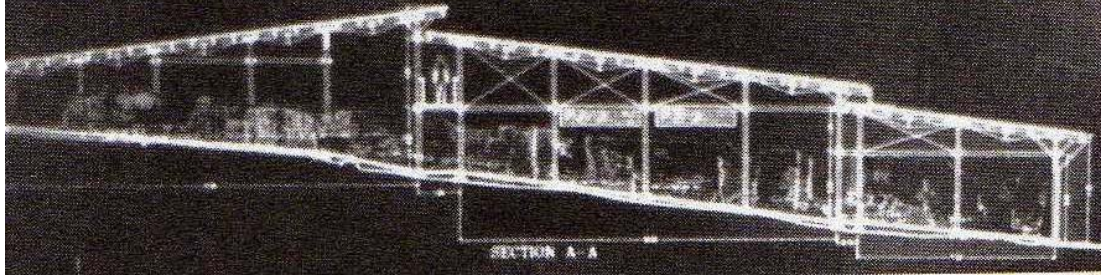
Arslantepe Höyüğü koruma strüktürü ve gezi platformu plan şeması (orijinal proje), (Porta, 2004).
